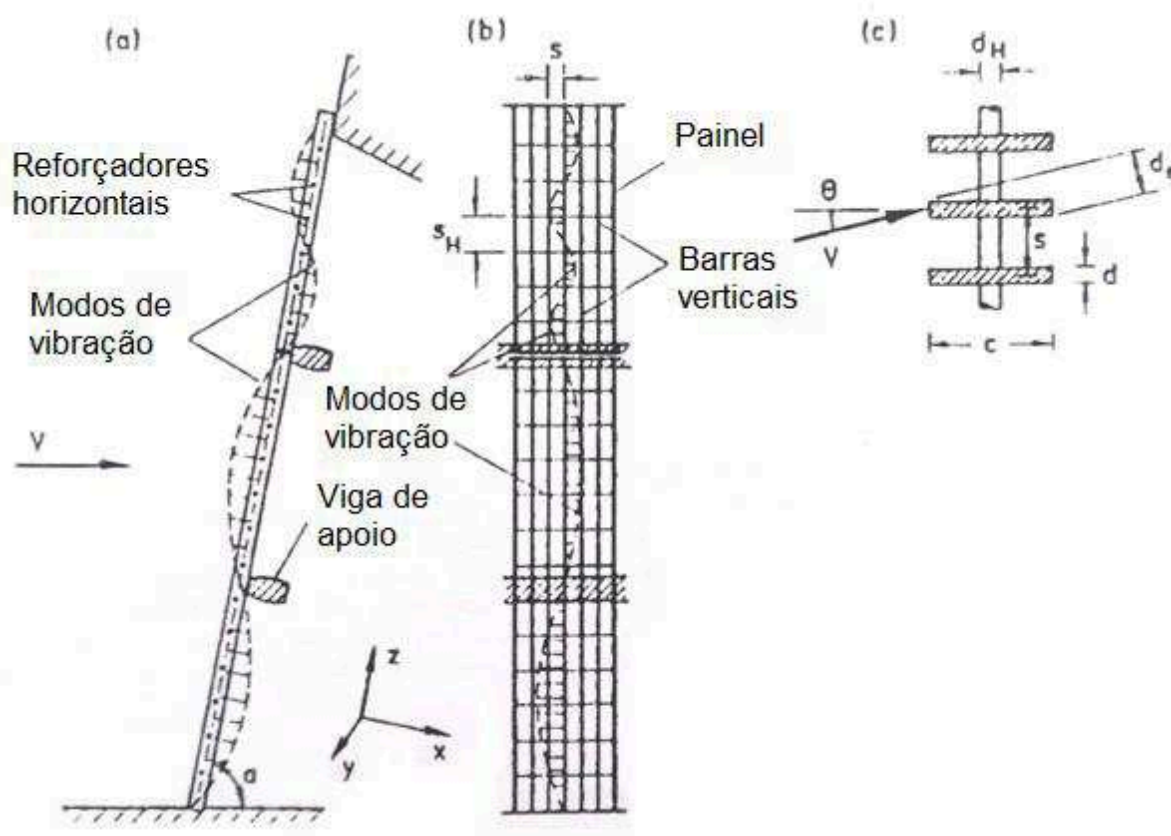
Definição dos modos de vibração e símbolos para uma grade típica: (a) Vista lateral; (b) Vista frontal; (c) Vista em planta.
